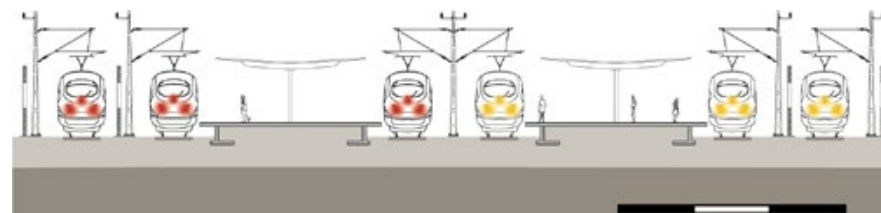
Exempel på station i betongtunnel, huvudbana med fyra spår.
